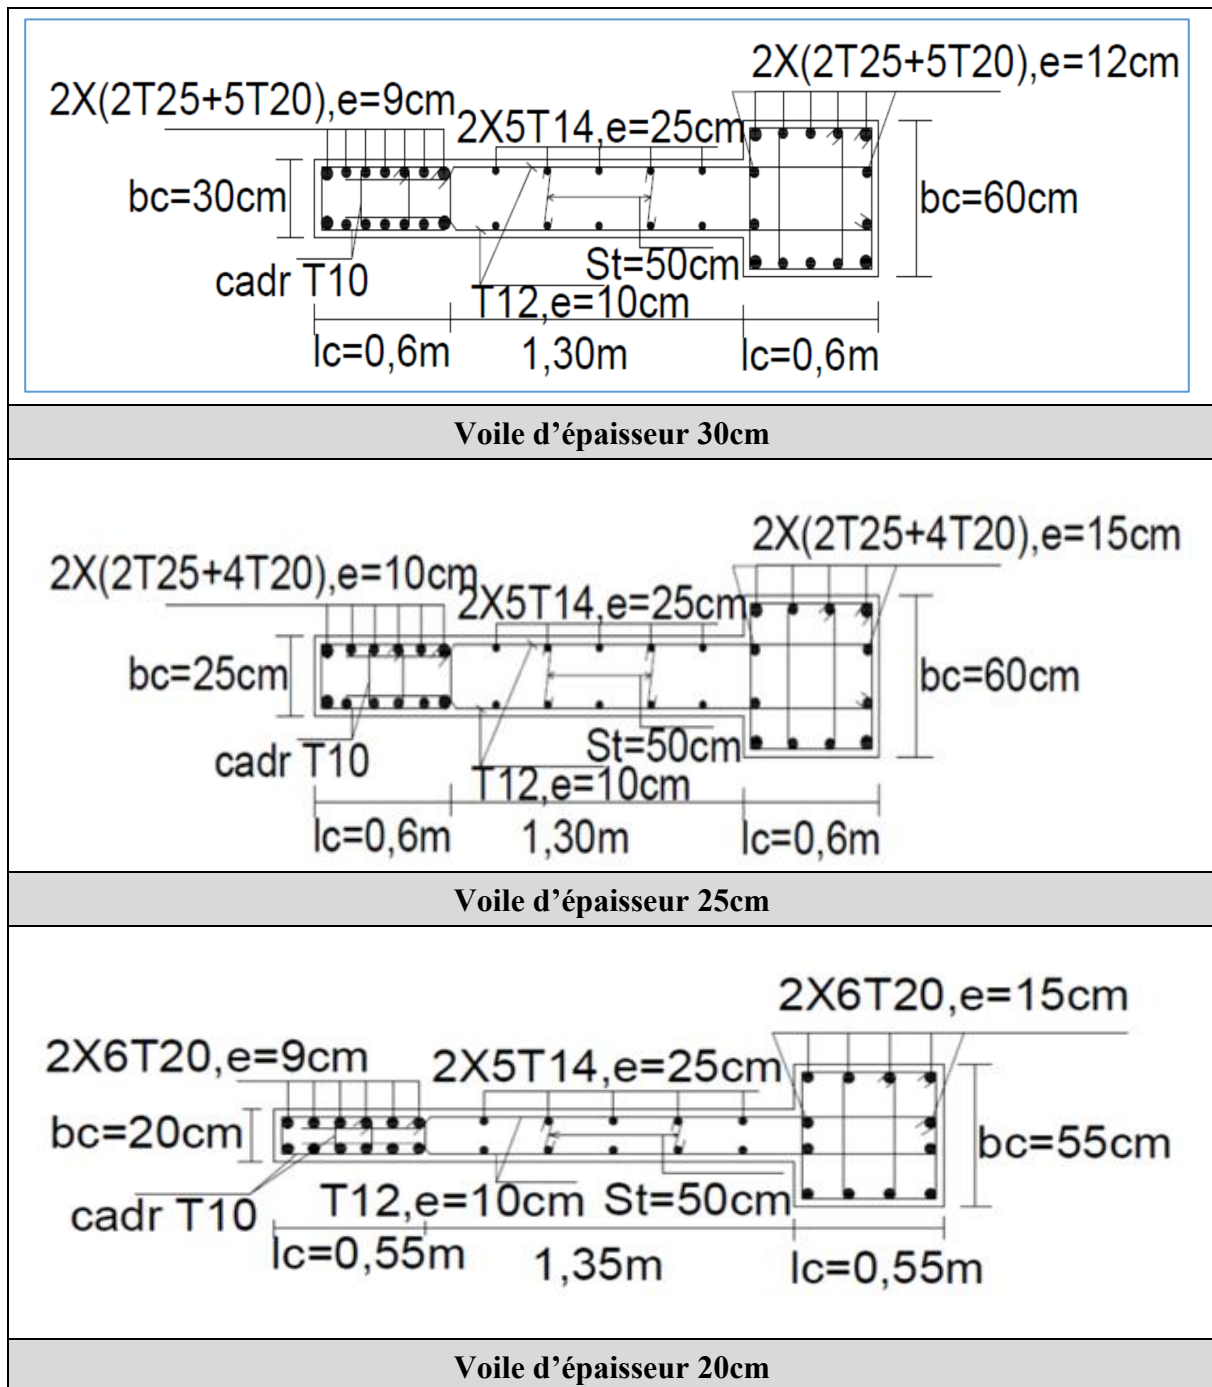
La coupe de ferrailage des voiles sens x.
